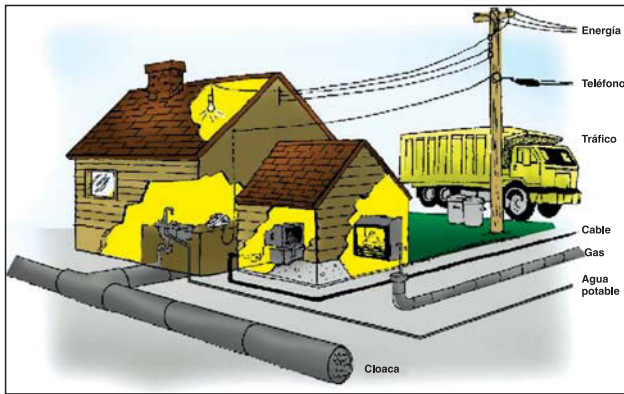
Sistemas de suministro de las viviendas tradicionales
